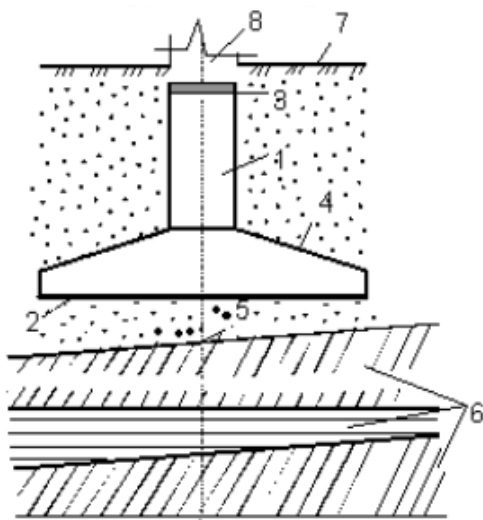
влаштування фундаменту мілкого закладення: 1 фундамент; 2 підшва фундаменту; 3 обріз фундаменту; 4 уступ фундаменту; 5 несучий шар ґрунту - шар, на який спирається фундамент; 6 підстилають шари ґрунтів; 7- поверхня землі; 8- надземна конструкція.
